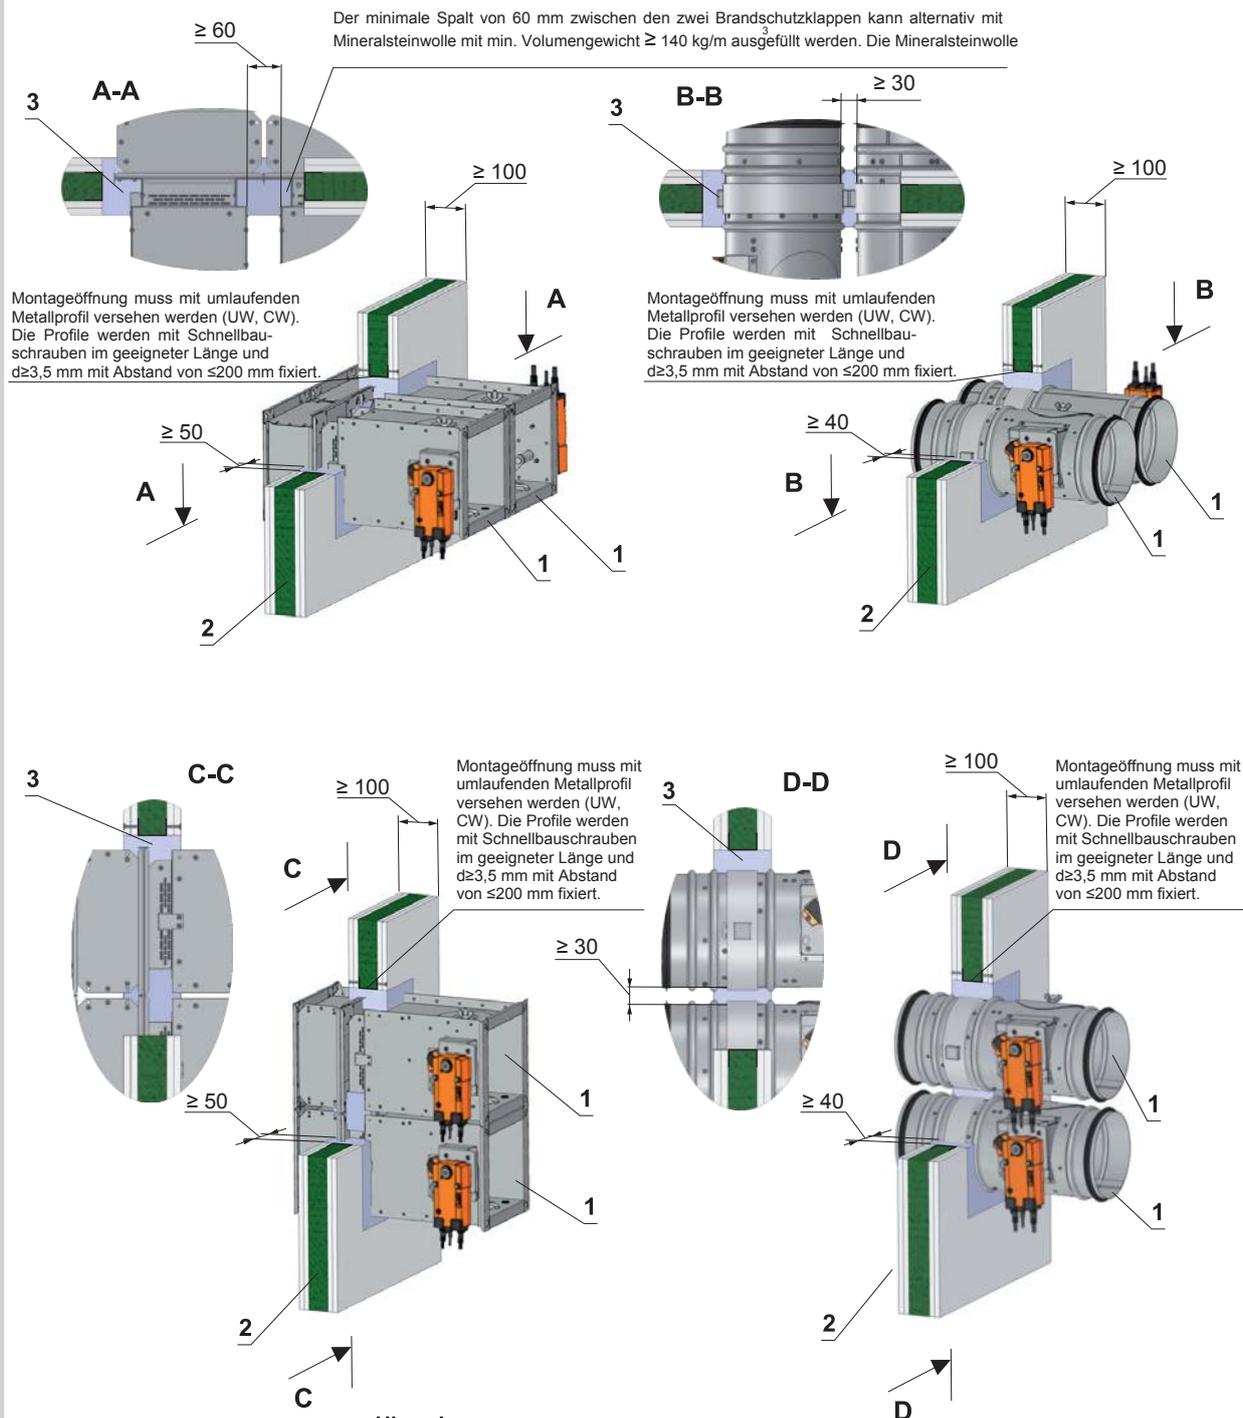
Leichtbauwände - Nasseinbau - Gips oder Mörtel
